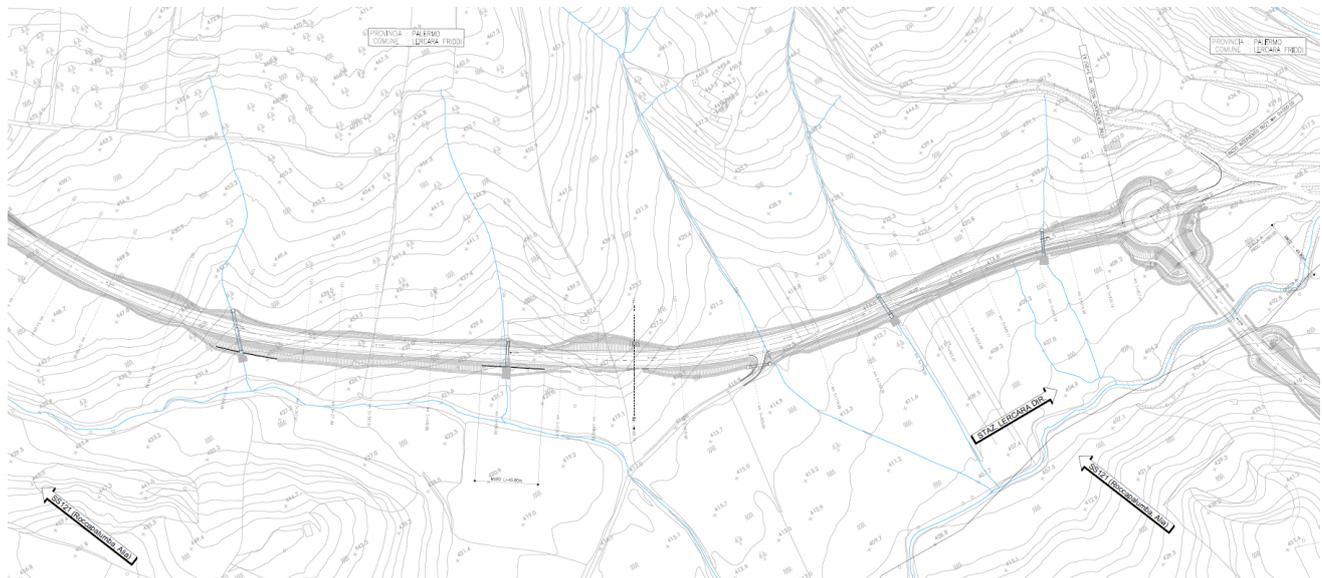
Planimetria di progetto dalla Km 5+145 a fine intervento NV20
